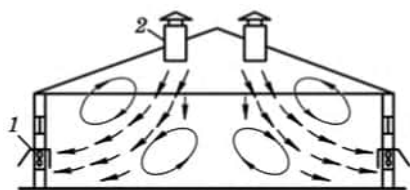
Вытяжная вентиляция помещений с настенными вентиляторами:
